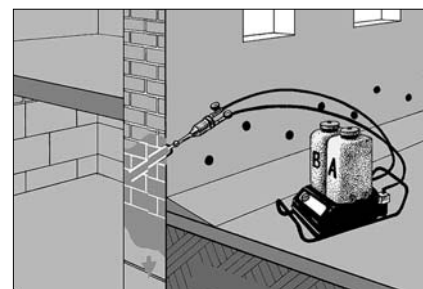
Схема заливки скважин гидрофобизирующим составом для горизонтальной гидроизоляции стены
